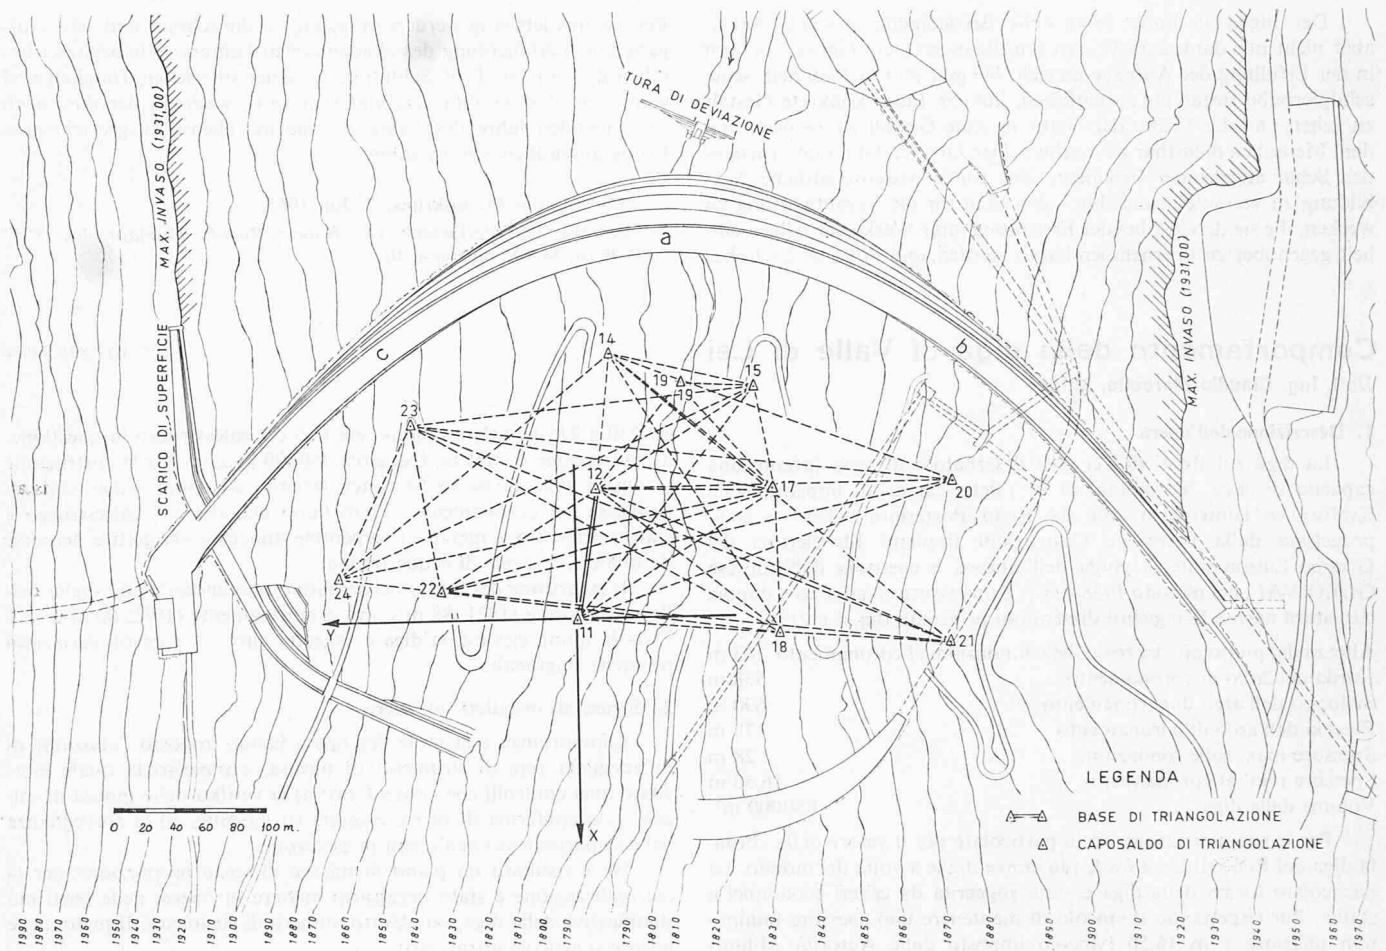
Pianta della diga, scala 1:5000, con schema planimetrico della triangolazione. a = concio 1, b = concio 13 sinistro, c = concio 13 destro
